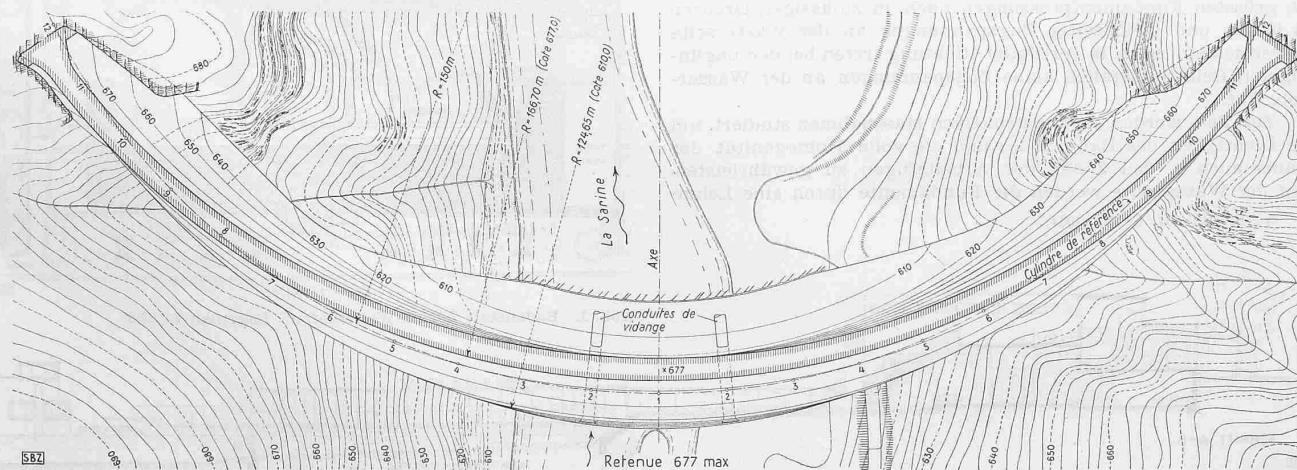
Grundriss (Schnitt Kote 677) der von Ing. H. GICOT (Fryburg) projektierten Staumauer Rossens. — Masstab 1 : 1500
